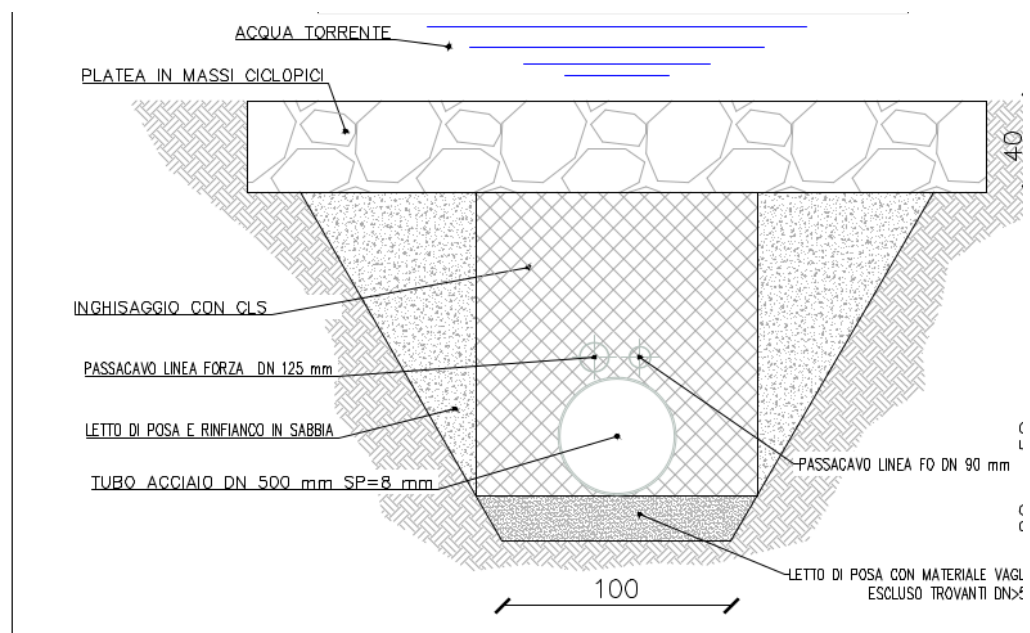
Sezione tipo dell'alternativa di attraversamento in subalveo
